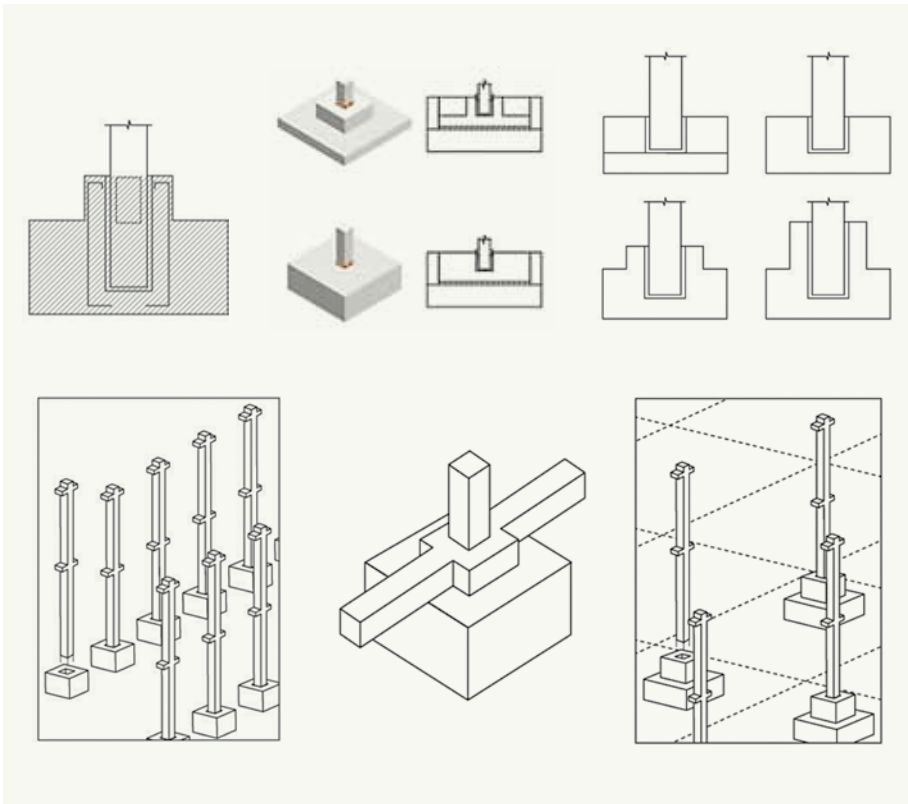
Encuentros pilar-fundación, en cajas de empotramiento.
